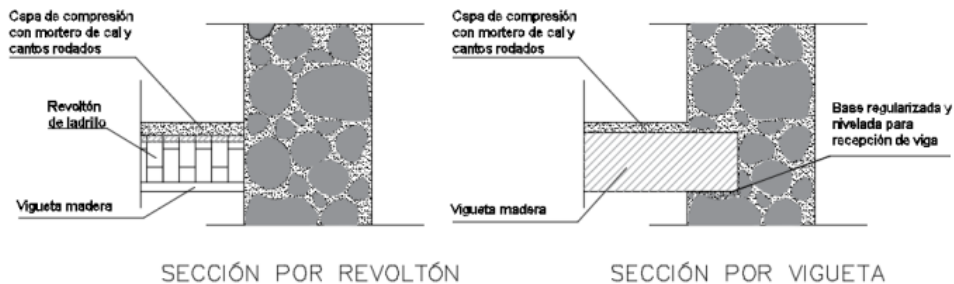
Detalle forjado-muro. 2016. Fuentes propias
